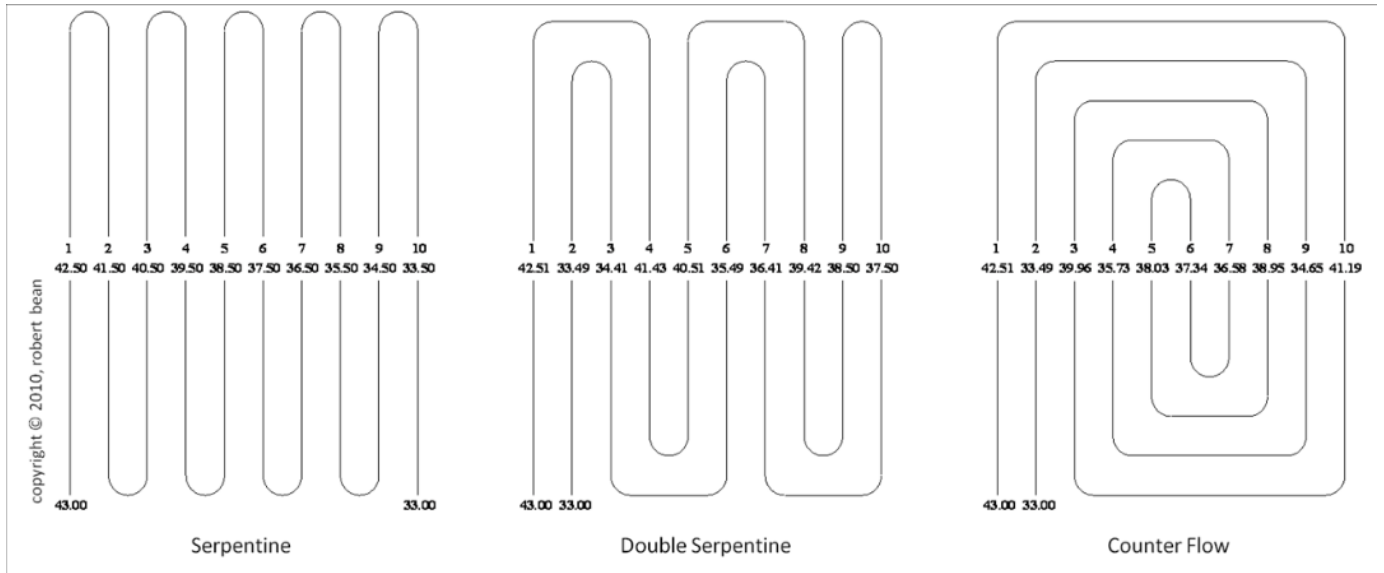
3 configuration possible pour la disposition du réseau de tube
